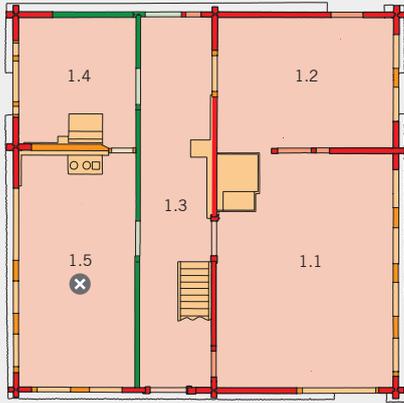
Unterägeri, Chammersbüel, Grundriss des ersten Vollgeschosses.
